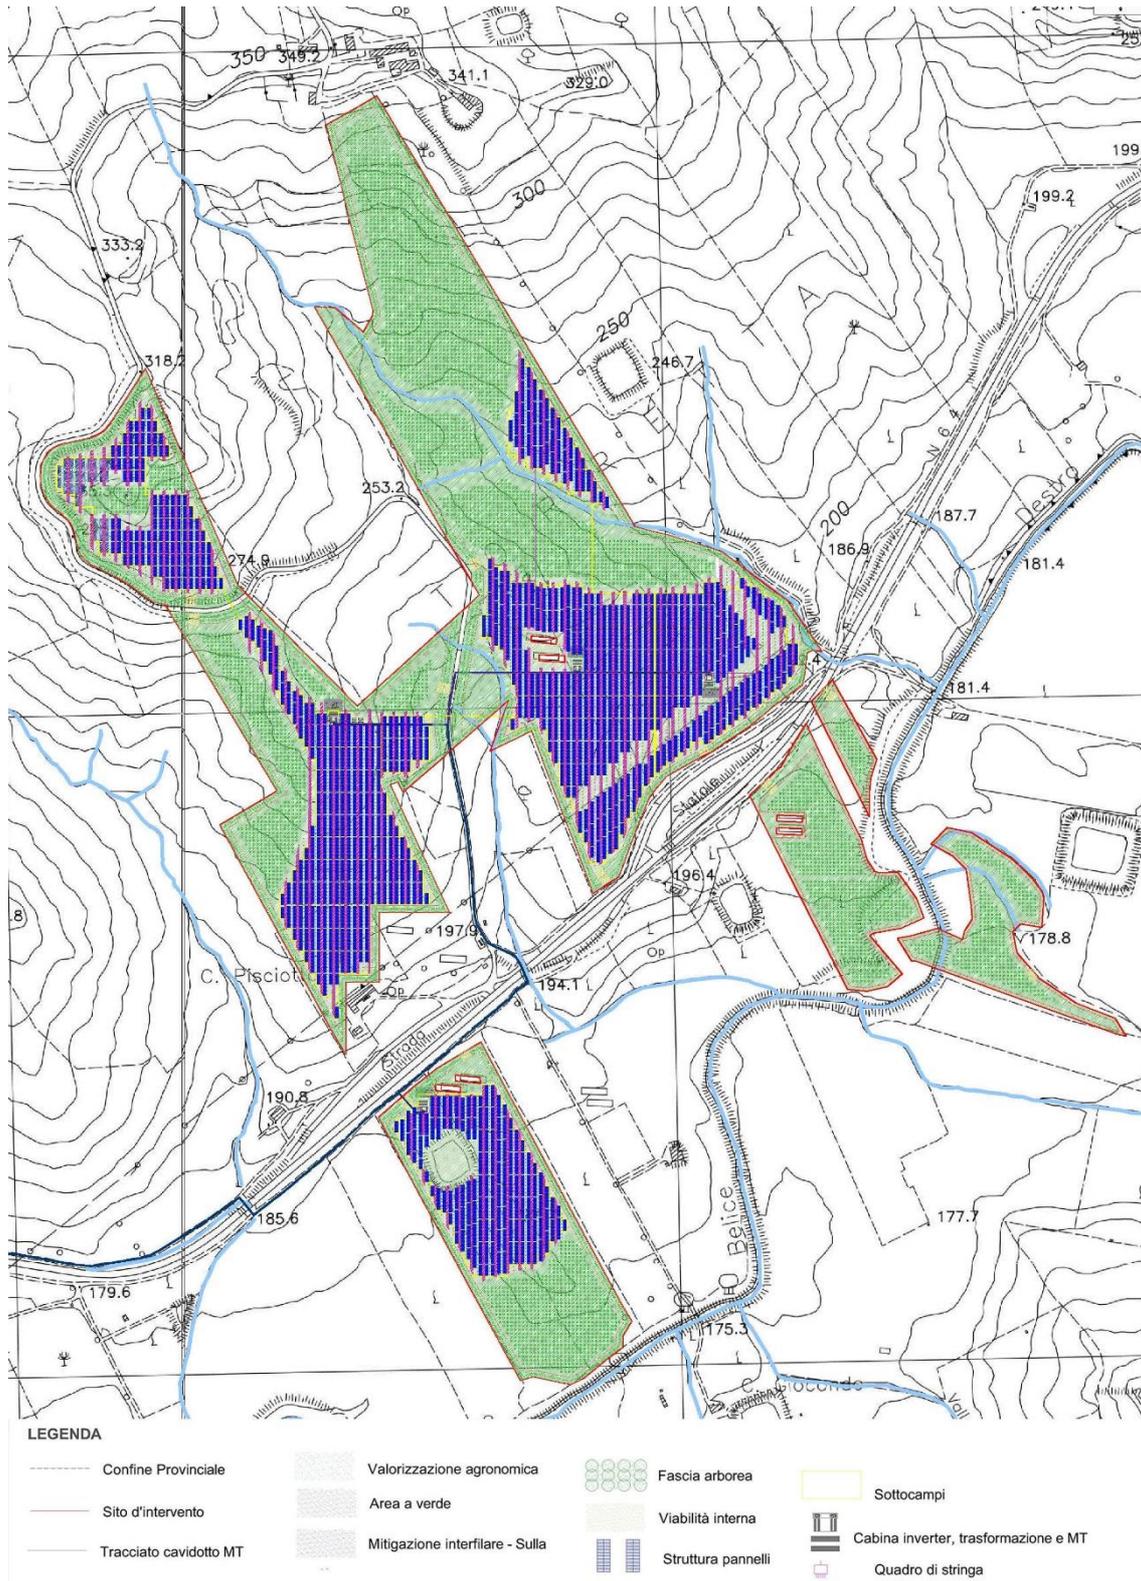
B – Layout dell'impianto ricadente in Contrada Torretta con cavidotto
